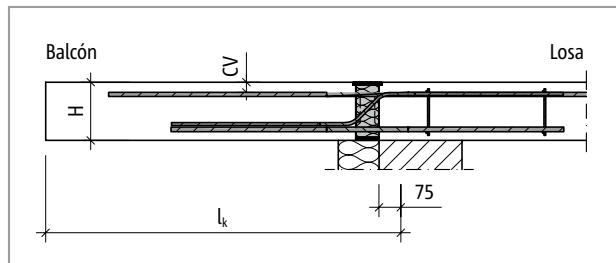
Schöck Isokorb® T tipo K-M13 hasta M14: Sistema estático
